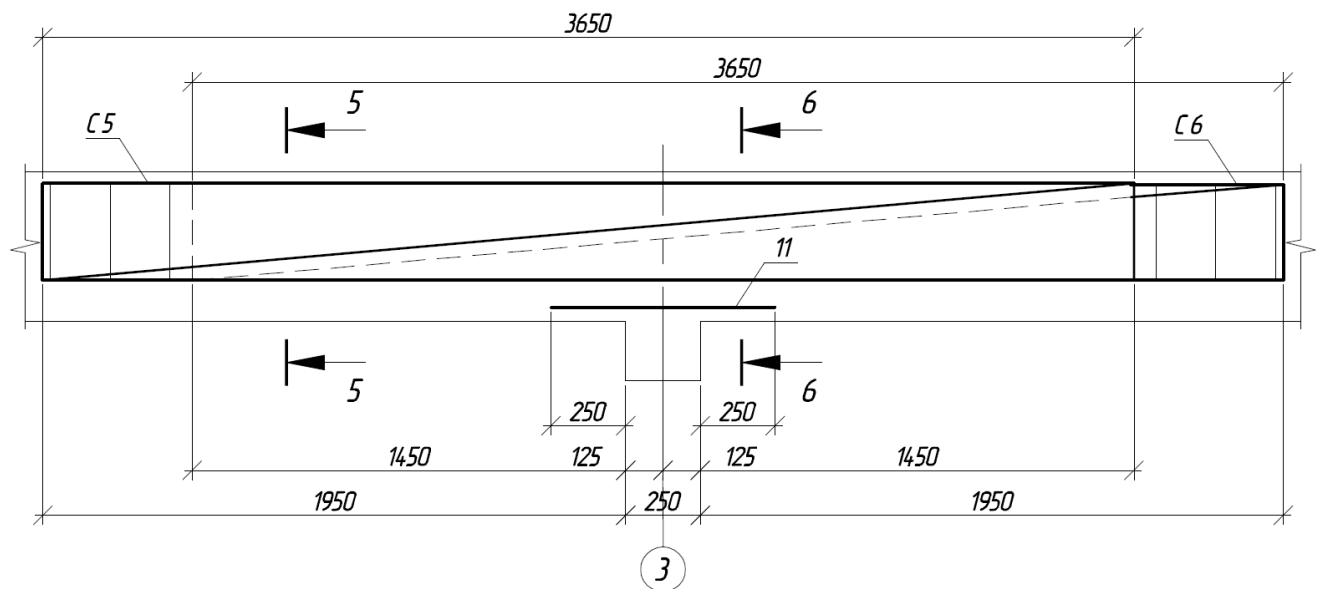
Схема армирования третьей опоры второстепенной балки
